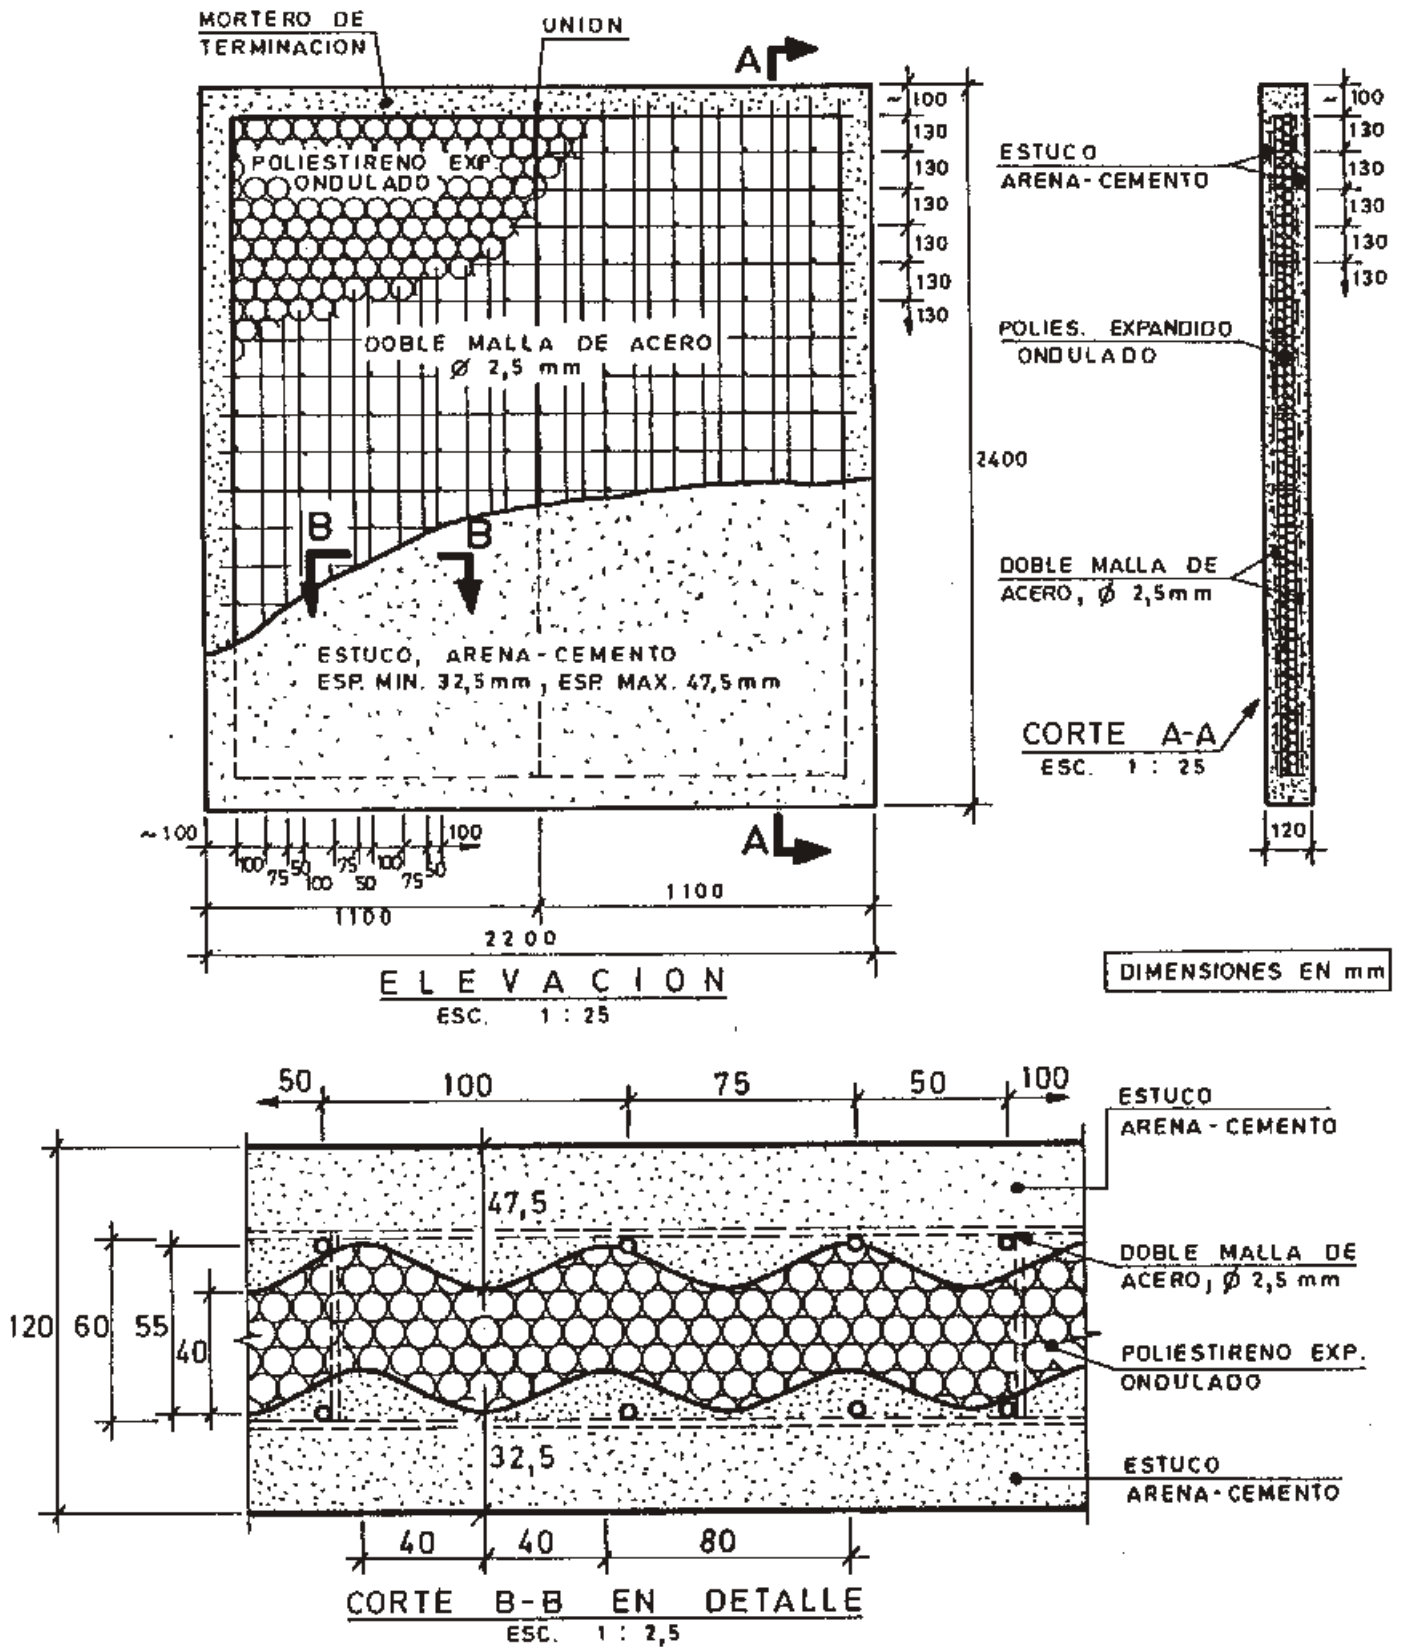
ELEVACION, CORTE Y DETALLE DEL ELEMENTO.
